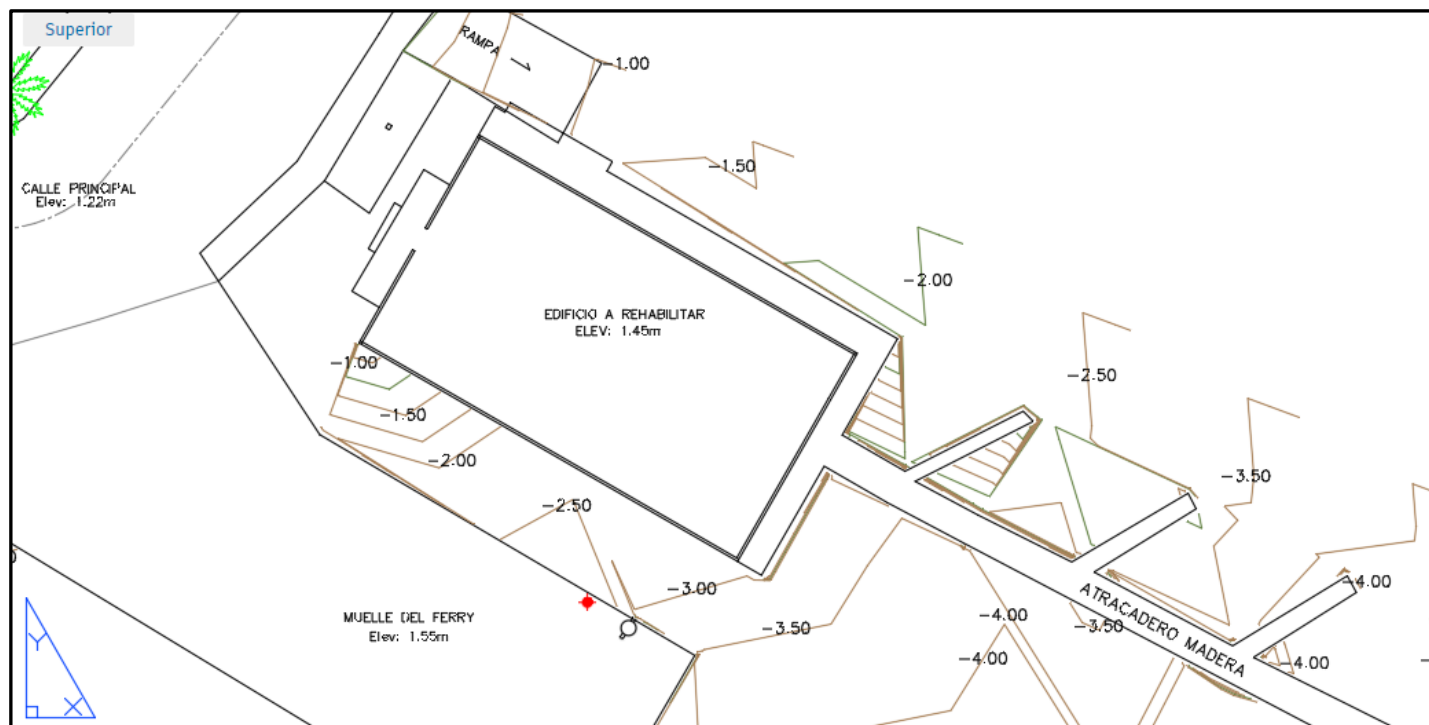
Detalle del Plano de la Topografía del proyecto donde se destaca la elevación de las principales infraestructuras y la calle principal
